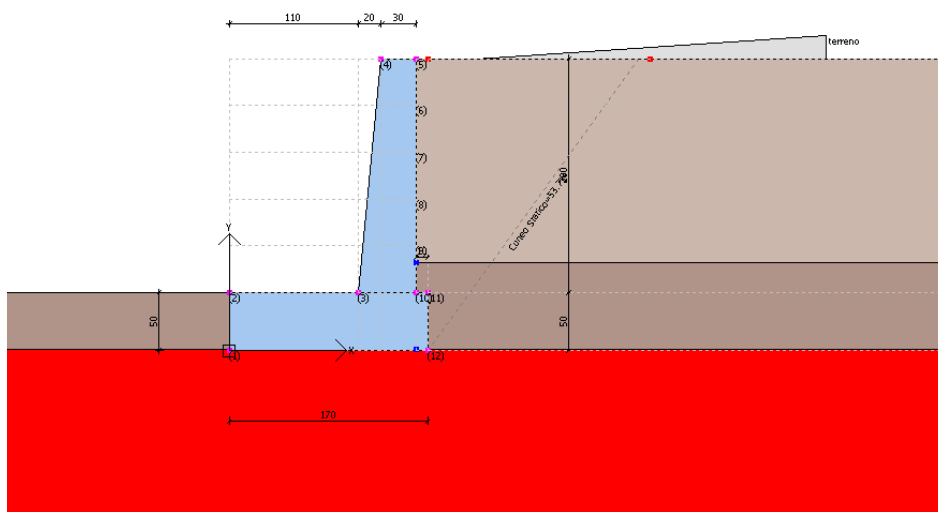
Geometria del muro M01 – Conci da 12 a 16 – Sezione di verifica
